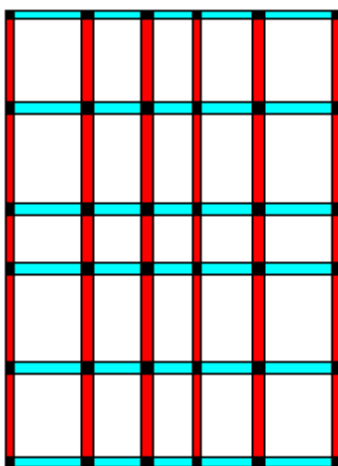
Disposición de las columnas y vigas en el sistema estructural de los edificios aislados de deriva 0,3%.
